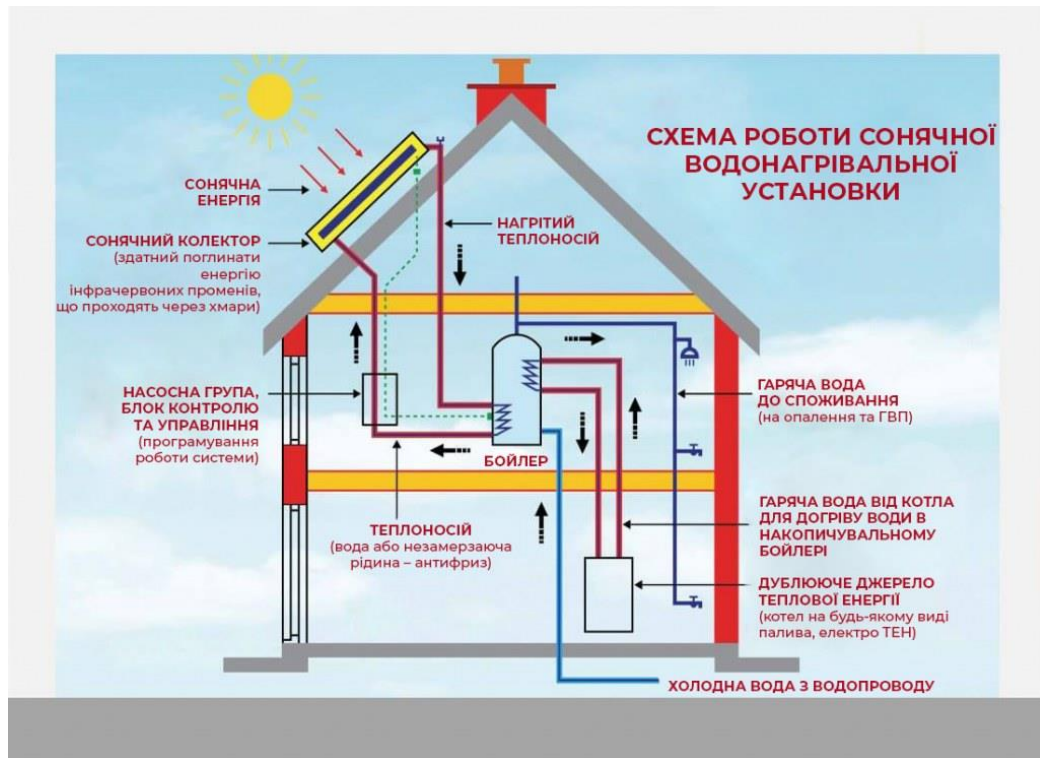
Схематичний принцип роботи сонячного колектора [16].
